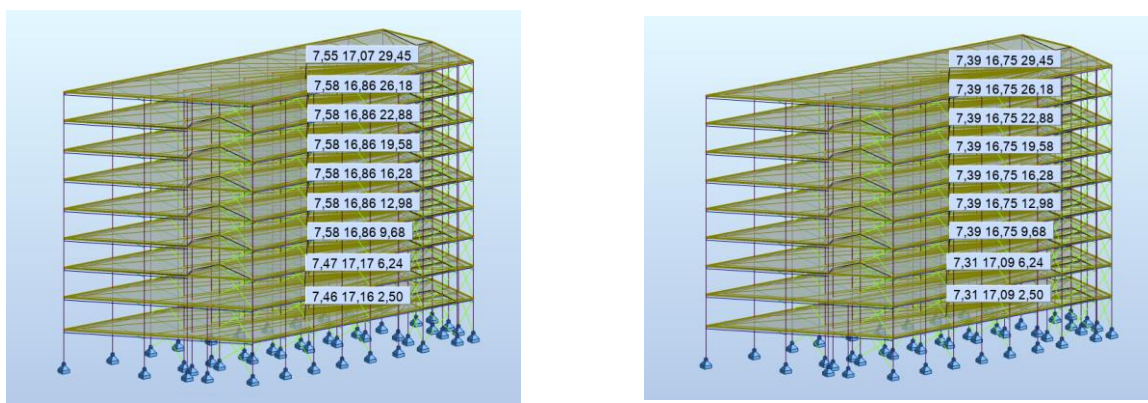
Centro de gravedad y centro de rigidez de las plantas del Modelo-1.
